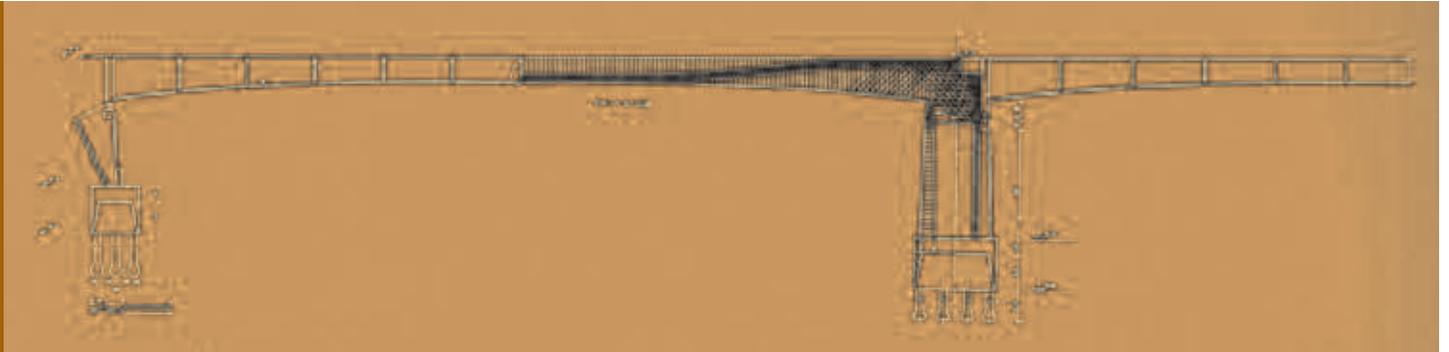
Sezione longitudinale parziale del ponte Amerigo Vespucci
